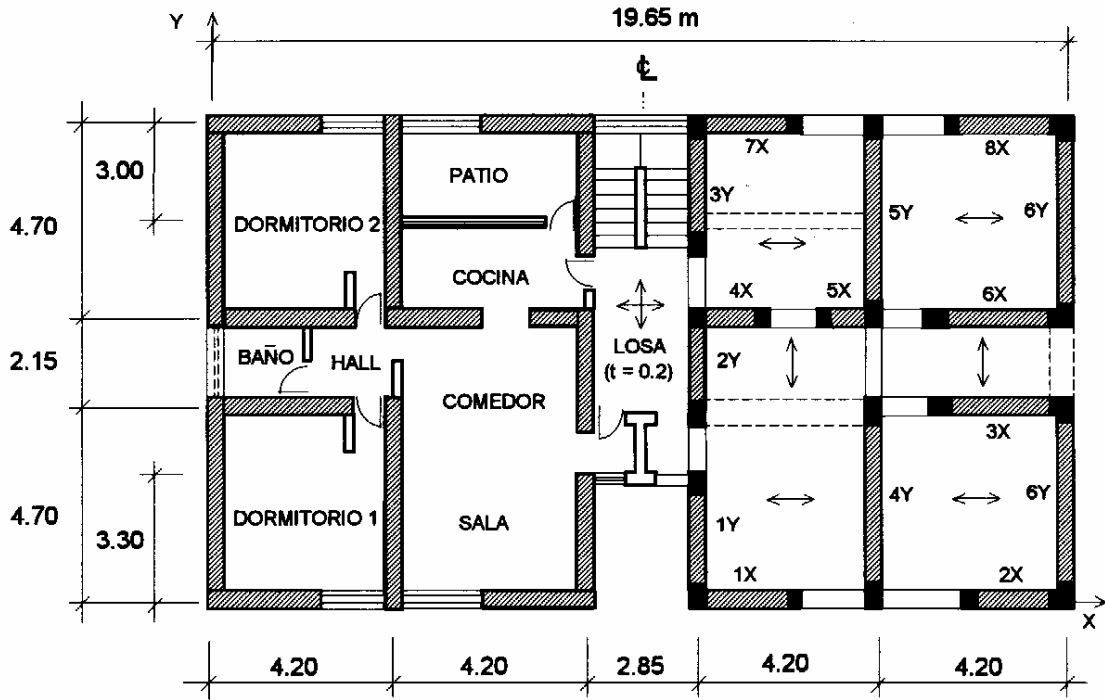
PLANTA TIPICA DEL EDIFICIO. ESQUEMA ARQUITECTONICO Y ESTRUCTURAL
